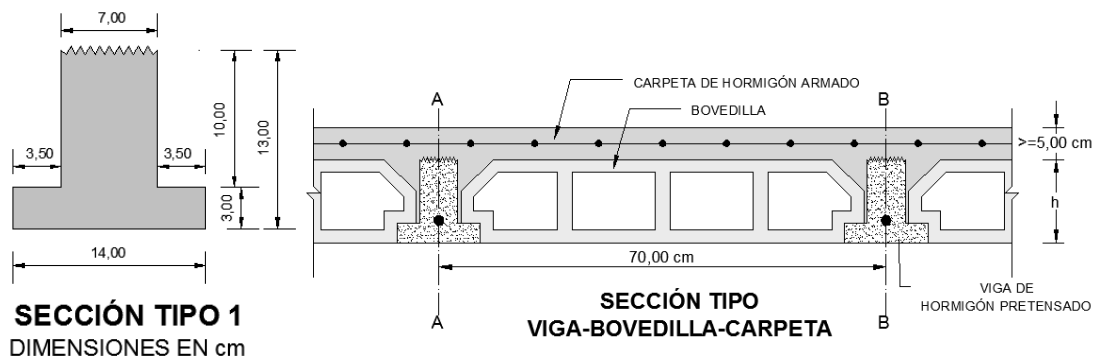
Sección Transversal inicial Viga de  $L=2,40$  m.
